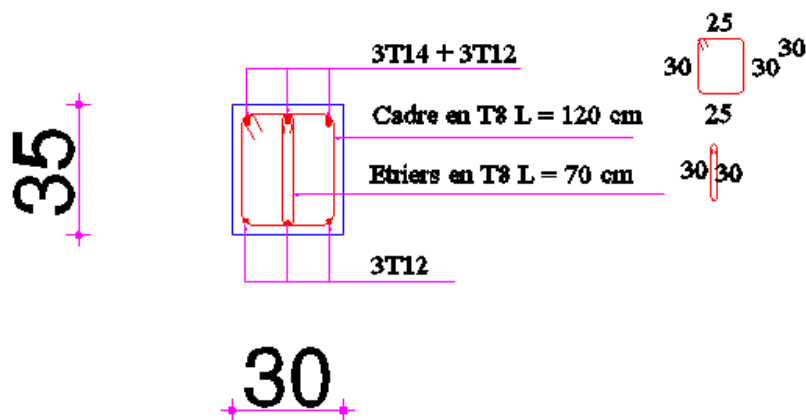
ferrailages des poutres secondaires sur appuis (30x35)
